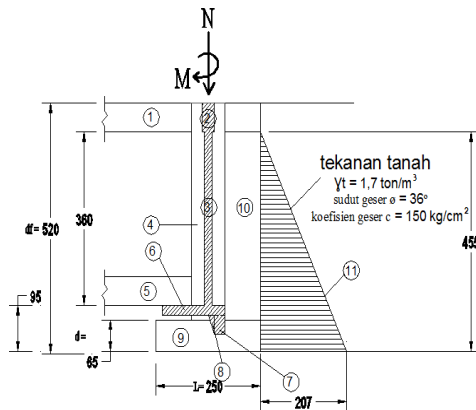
Resume Beban Rencana Pada Pondasi
